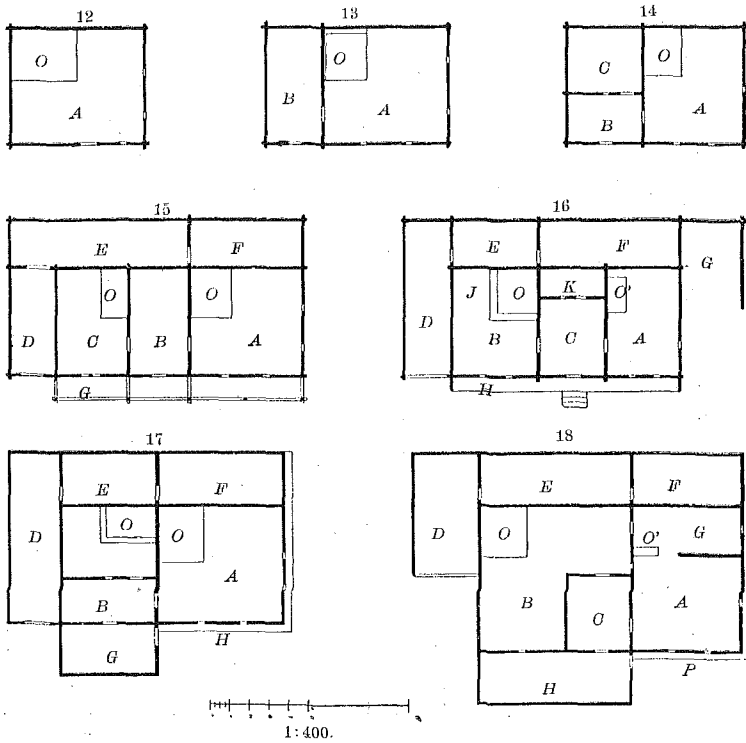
18. Grundrisse typischer Bauernhäuser.
